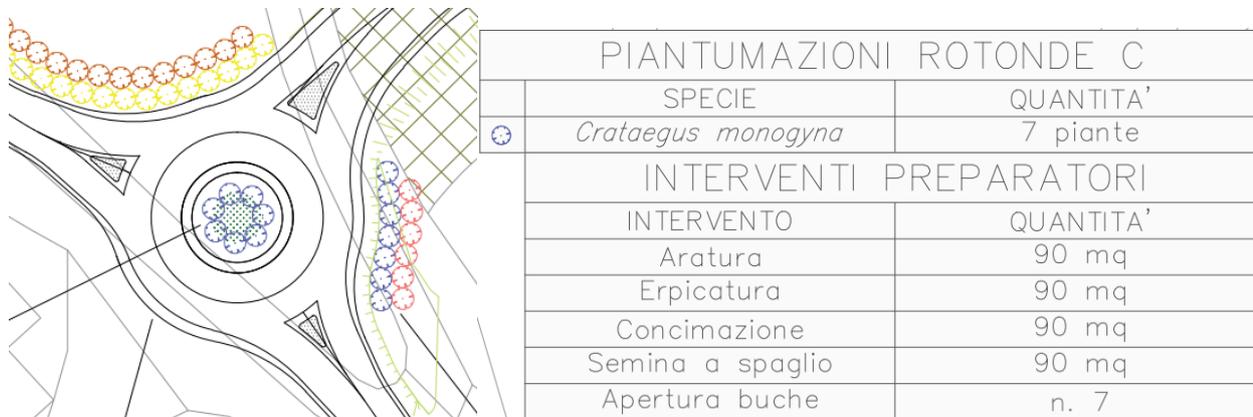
Estratto Elaborato P00_IA00_AMB_PP01 Planimetria opere a verde
